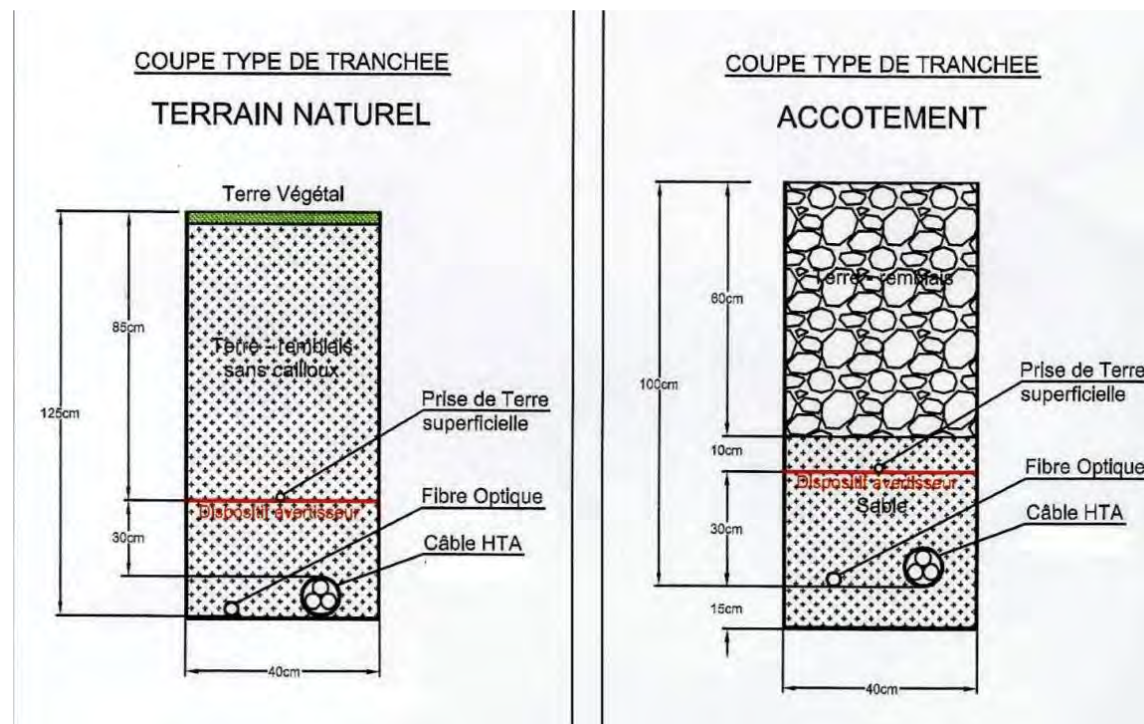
Coupe type de tranchée pour le câblage interne ©WPD
